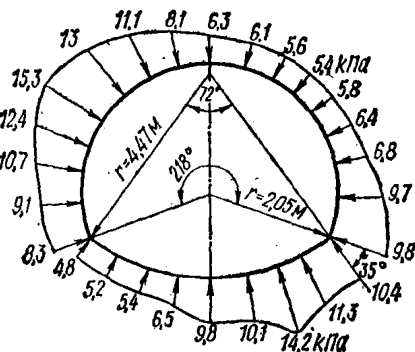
Геометрическая схема крепи и эпюра нормальных нагрузок
